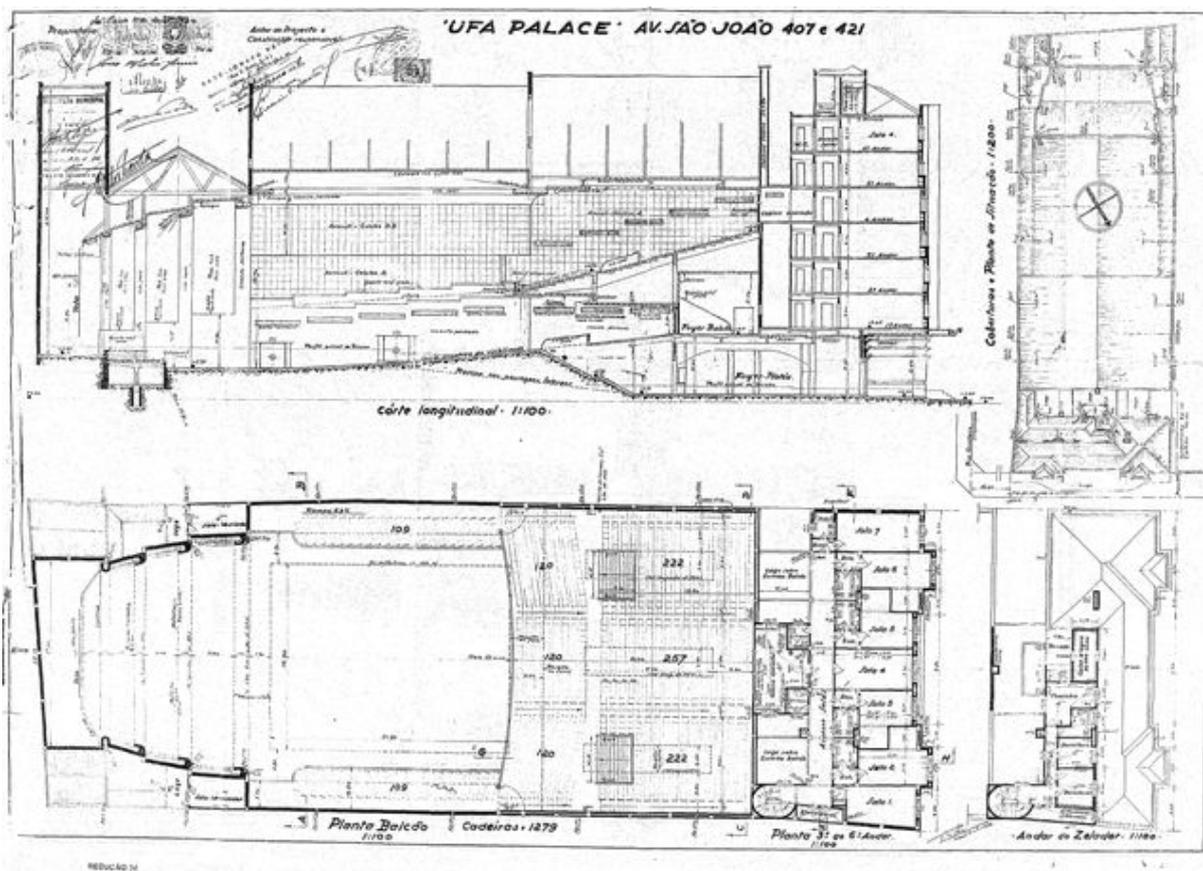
Art Palácio - Planta do térreo e corte longitudinal.
